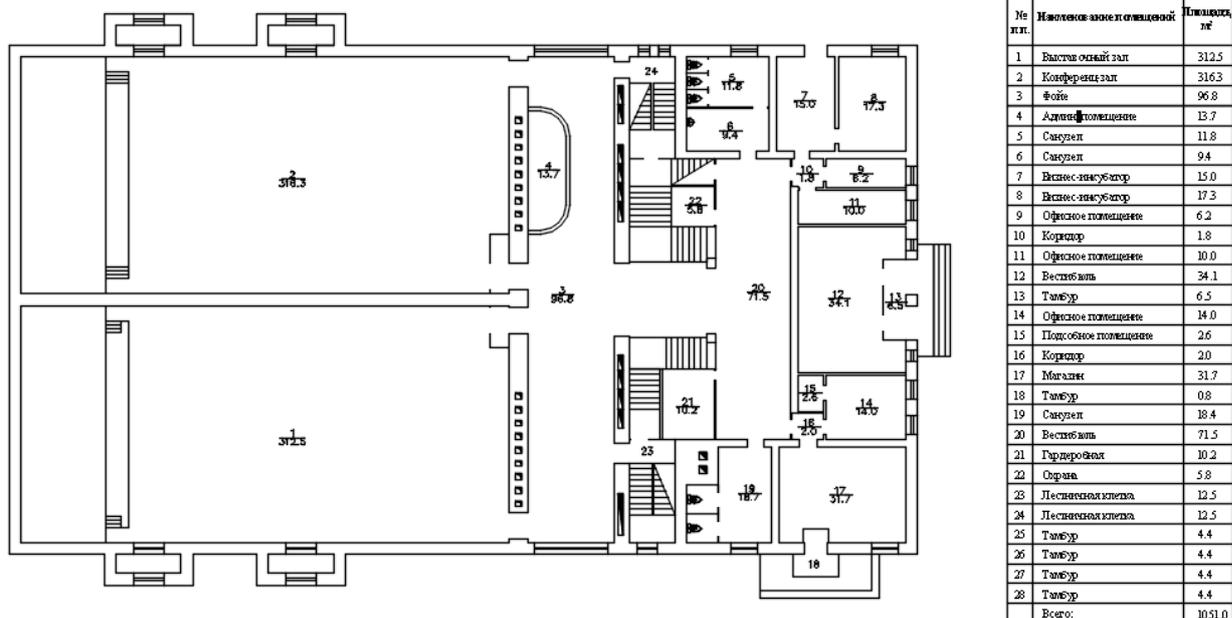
План помещений первого этажа АДЦ со спецификацией помещений
